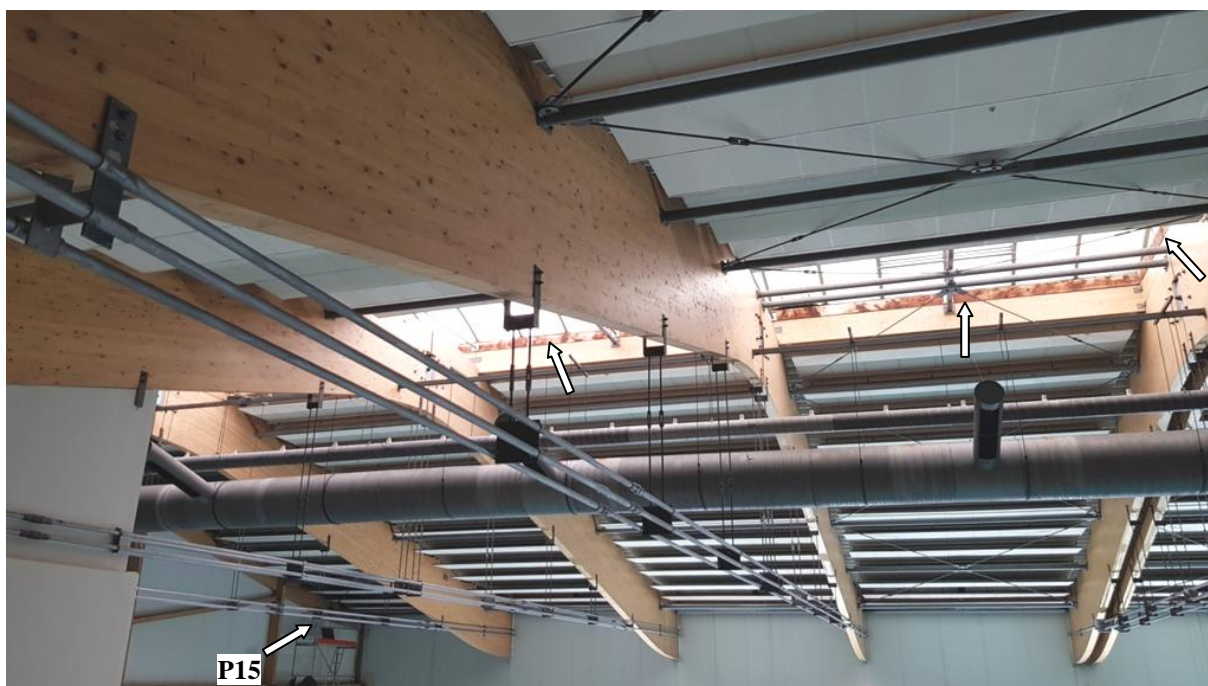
Pływalnia – liczne zacieki z dachu po długości ściany zewnętrznej, korozja biologiczna drewnianej podstawy świetlików dachowych.
